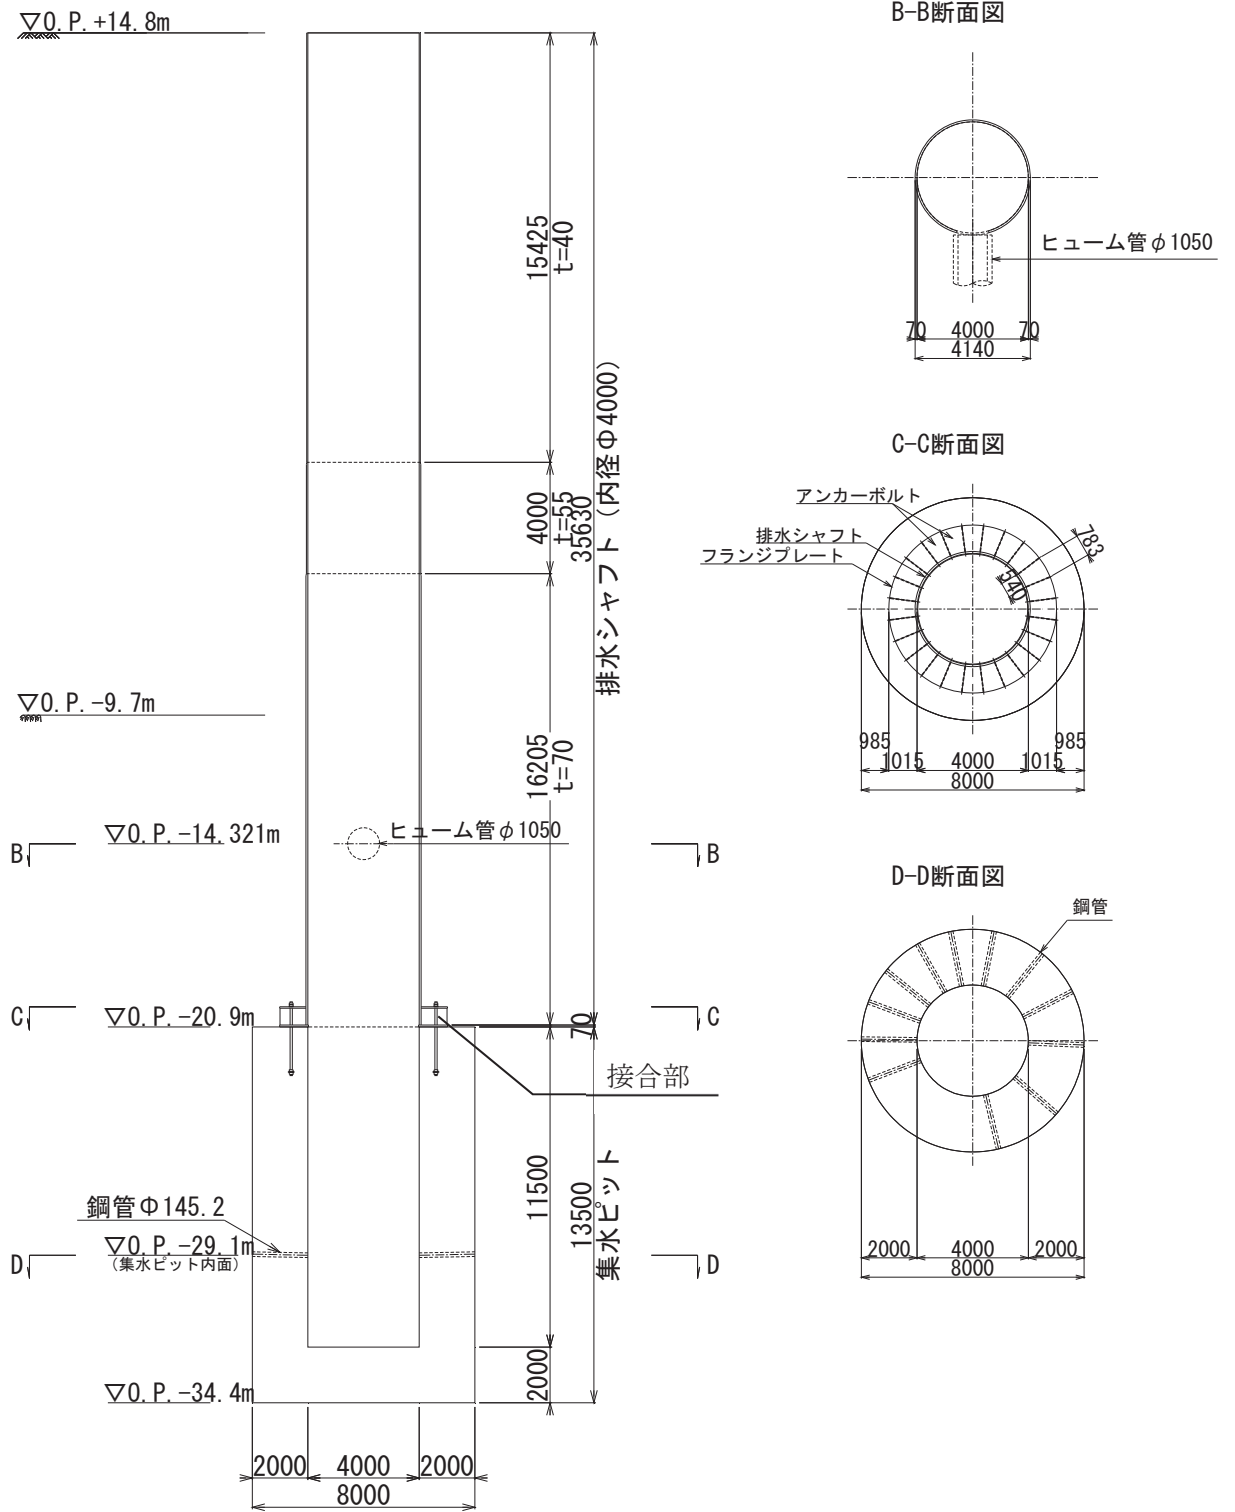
(2) No. 2 揚水井戸 構造概要 (単位 : mm)
